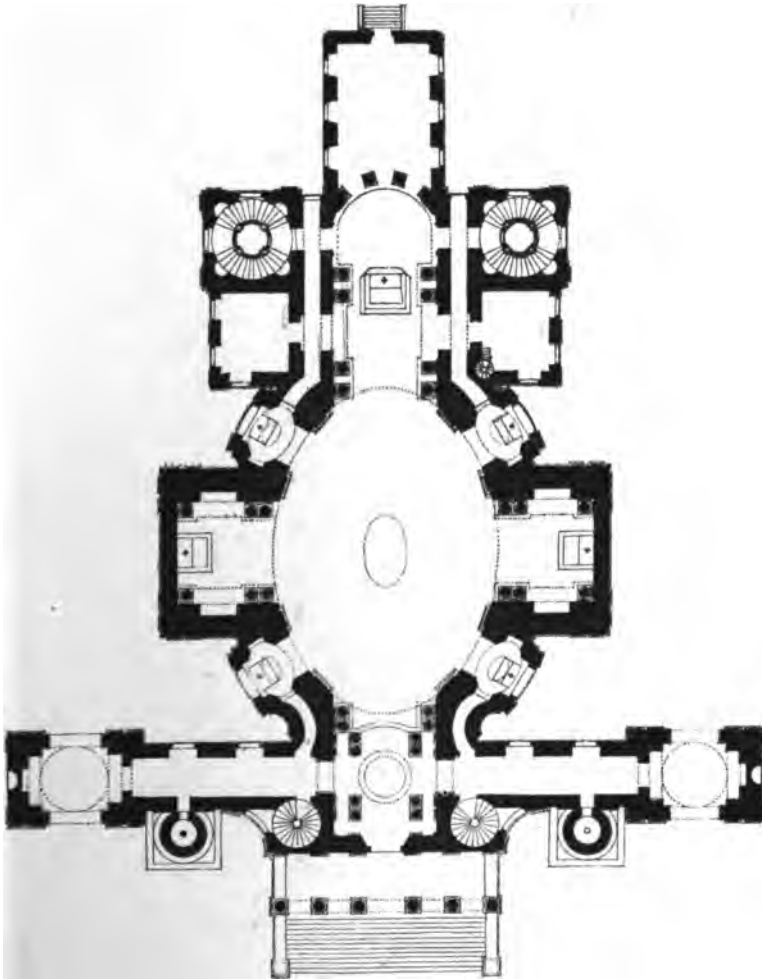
Grundriss der Karlskirche in Wien.
